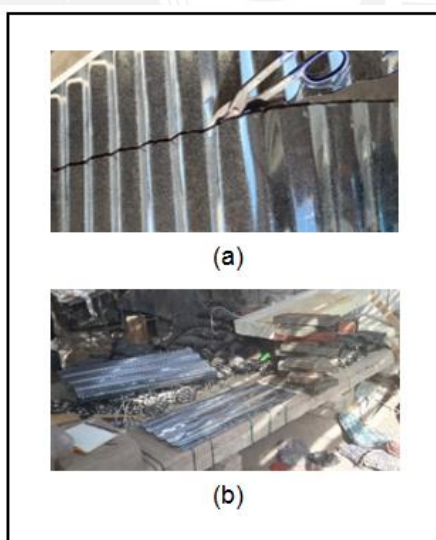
Fabricación y colocación de platina sobre la viga de concreto
